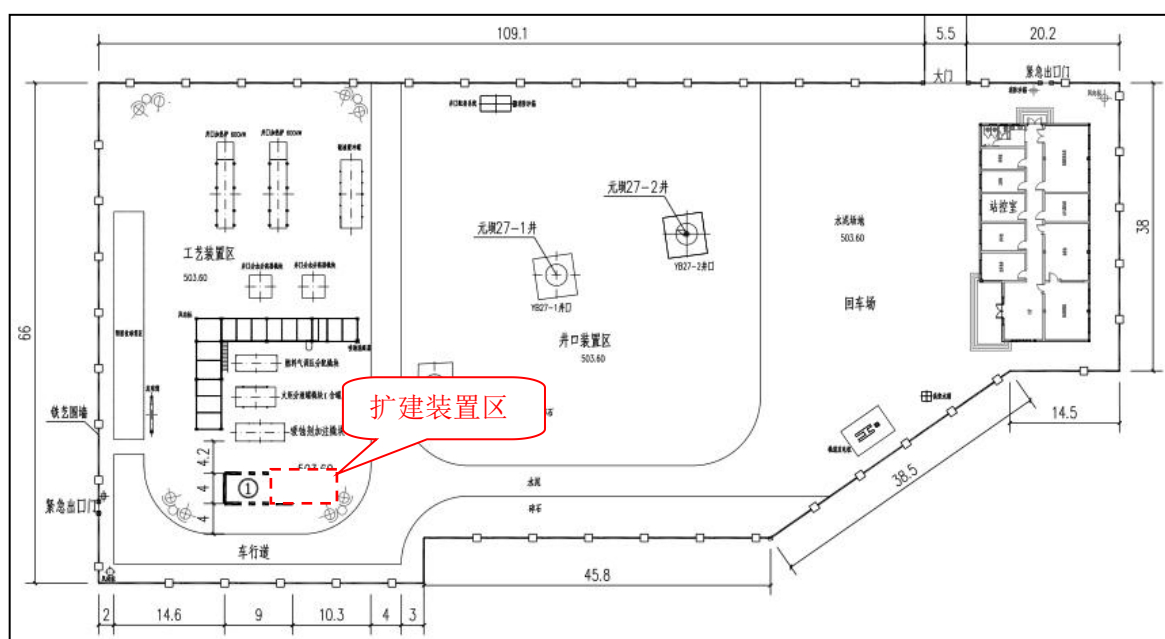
元坝 27-1/2 井站扩建装置区域平面布置图
